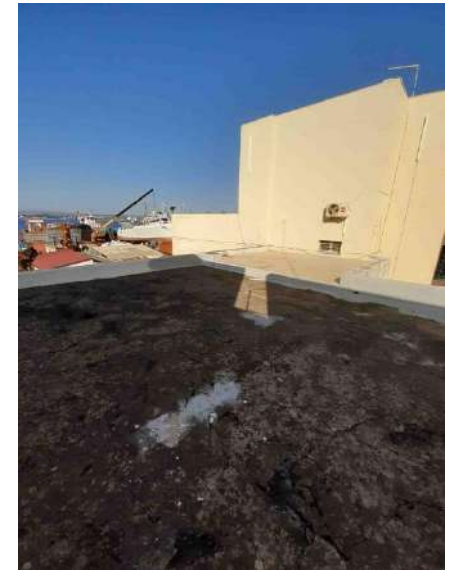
Servizio igienico (WC1) - Foto 29 - Servizio igienico (WC1) - Foto 30 - Lastrico solare 1° Livello - Foto 31 - Lastrico solare 1° Livello
